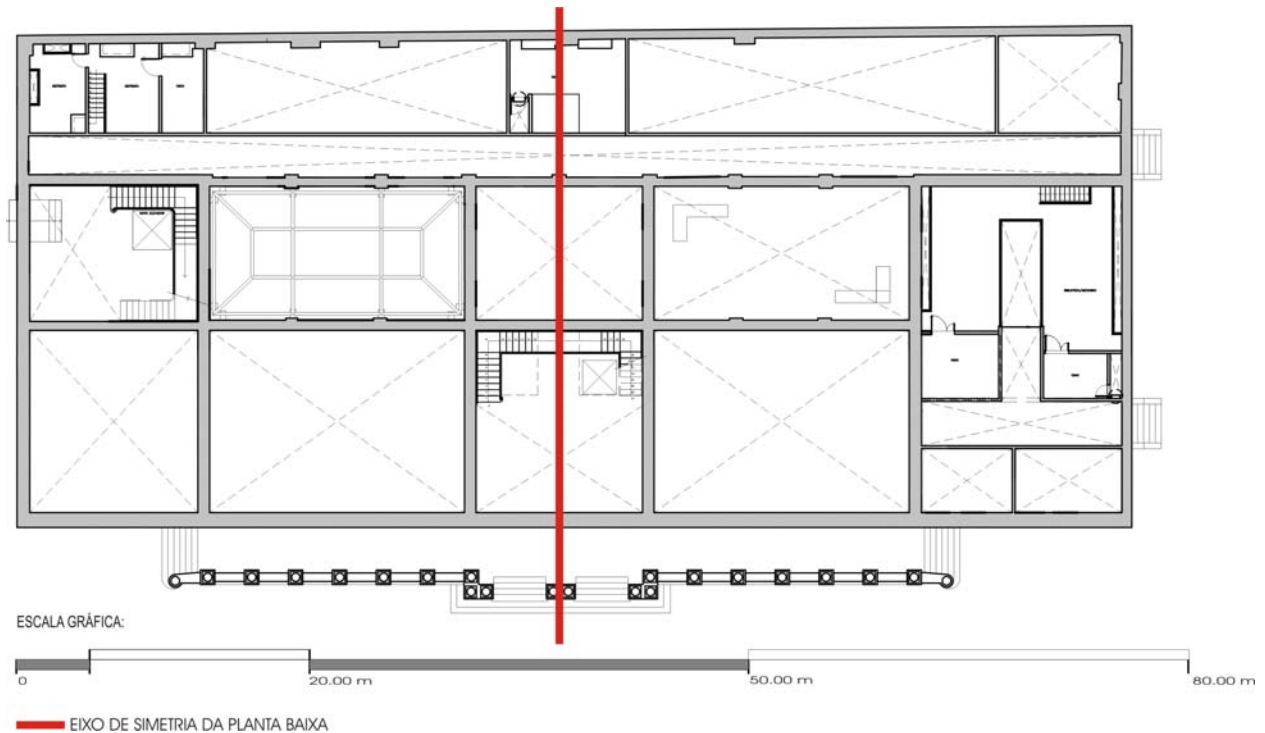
Planta baixa do mezanino – simetria da edificação e dos ambientes.
